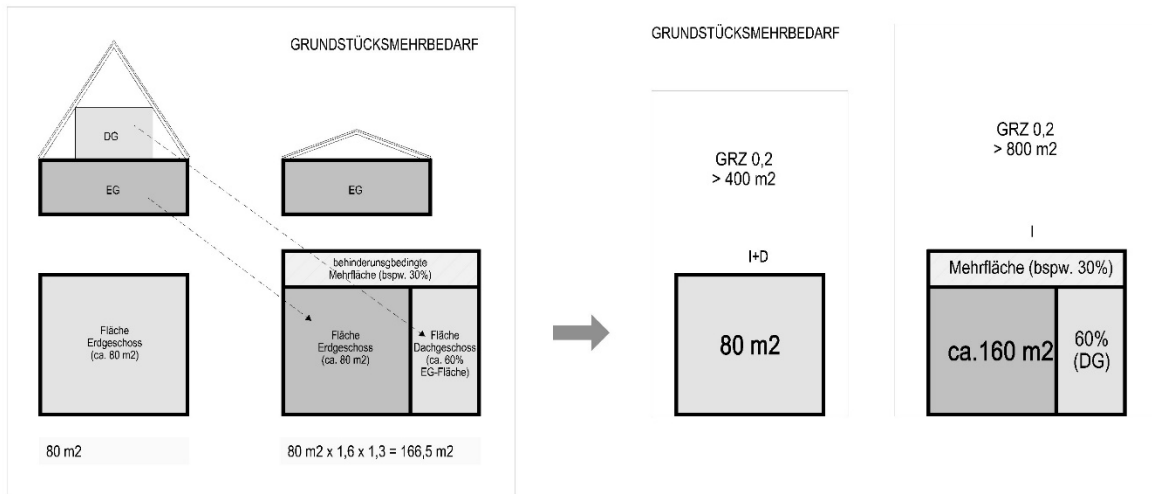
Beispiel für Grundstücksmehrbedarf bei eingeschossiger Bauweise
